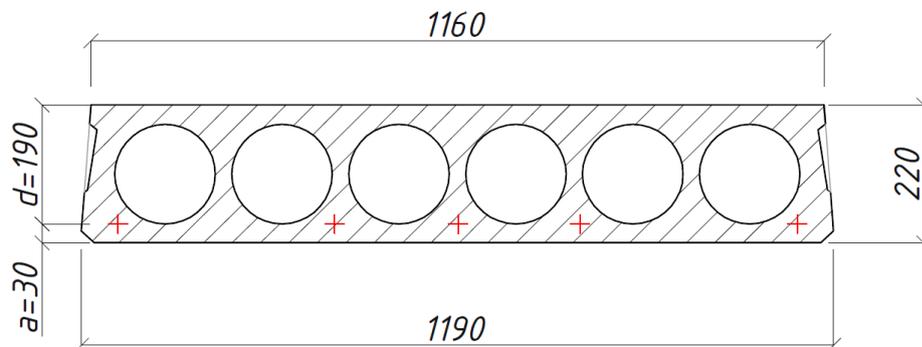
Поперечний переріз з розмірами та розташування поздовжньої арматури у плиті
